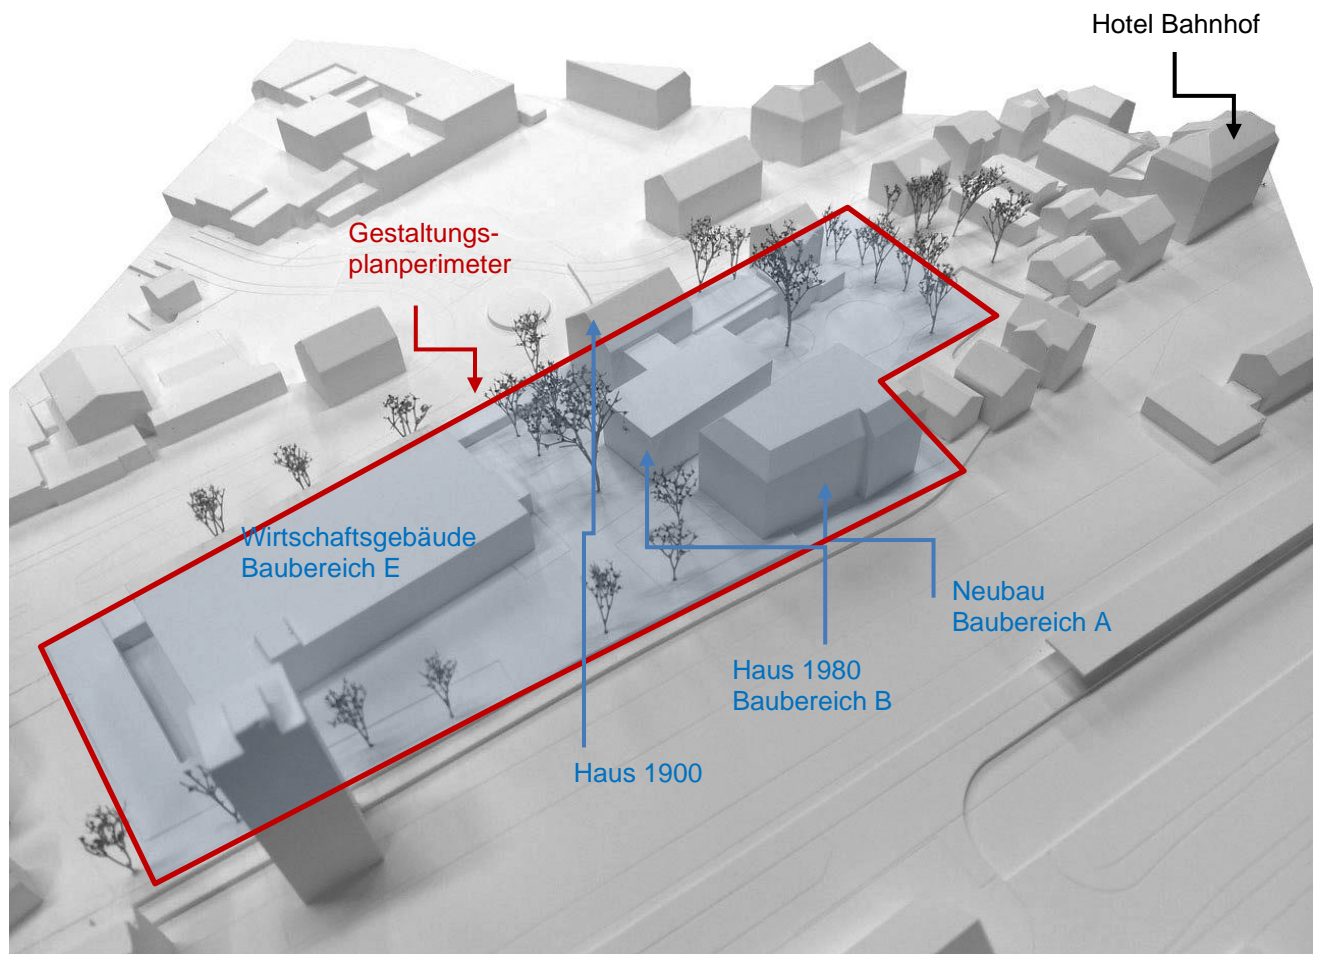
Foto Gipsmodell Planerwahlverfahren
